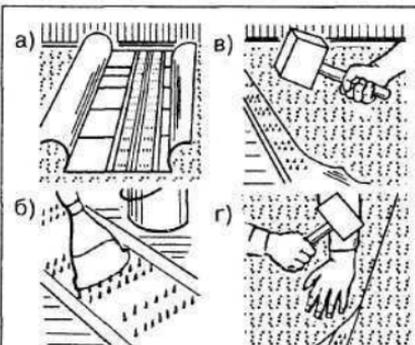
Плоские металлические планки с шипами для соединения ковровых покрытий пола: а – стык; б – нанесение мастики; в, г – укладка
